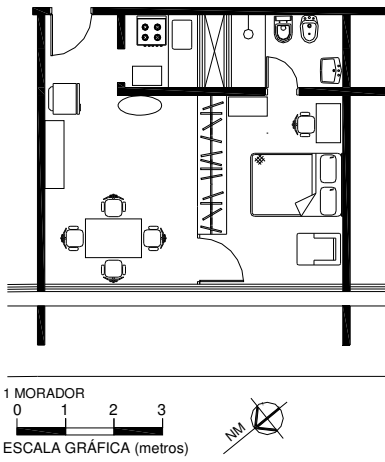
Layout de apto. de 1 dorm. bloco B. A separação da área de dormir é proposta no projeto inicial de Niemeyer.
